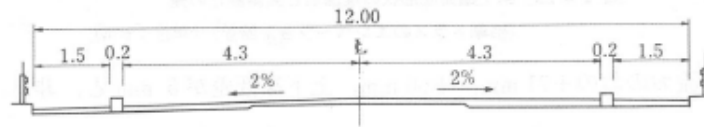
橋面舗装の施工標準断面 (単位: mm)
